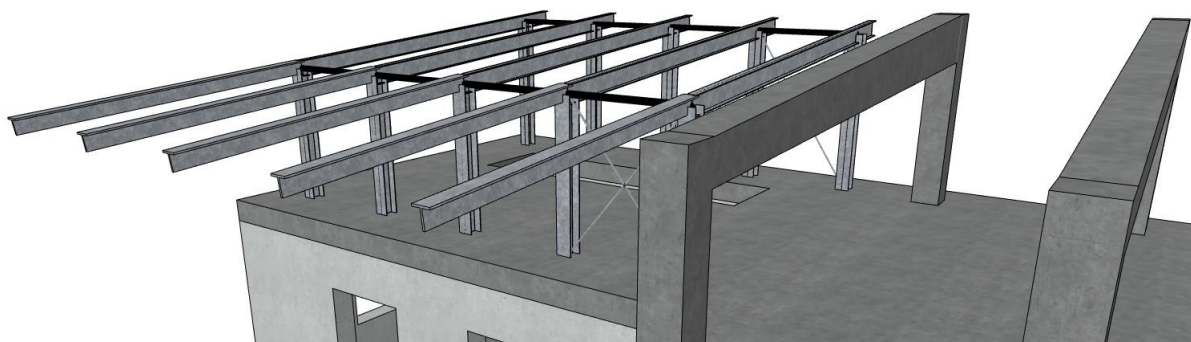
Dachkonstruktion bestehend aus Stahlbauprofilen und rechteckigen Stahlbetonstäben
